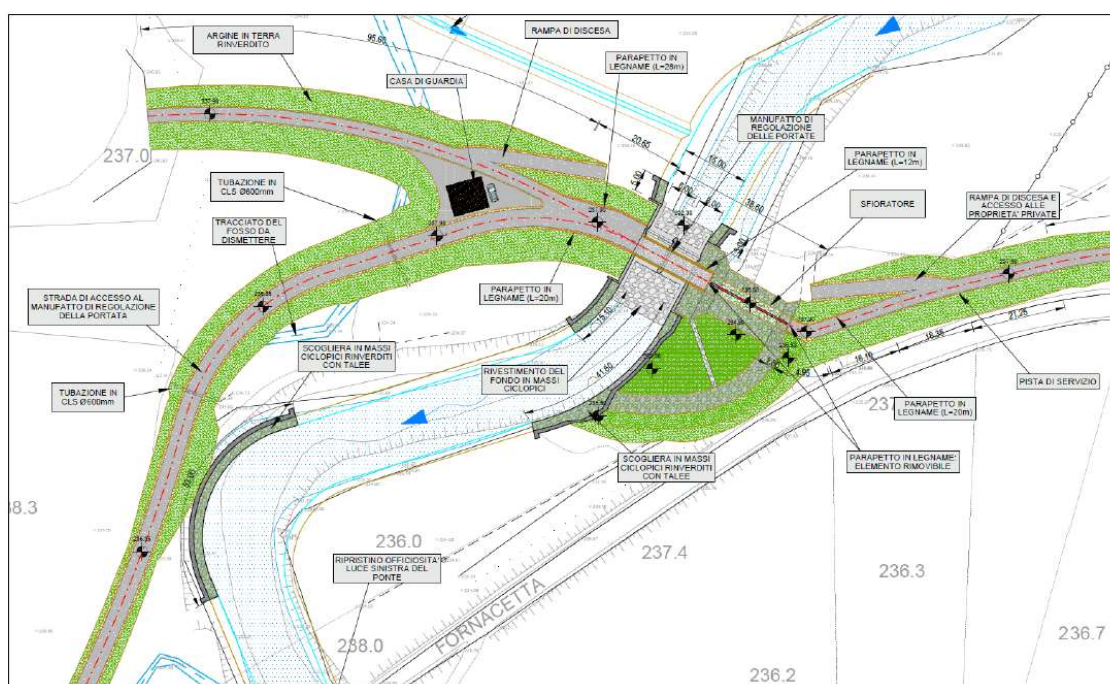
Planimetria di progetto del manufatto di regolazione dell'area di laminazione di Inverigo.
